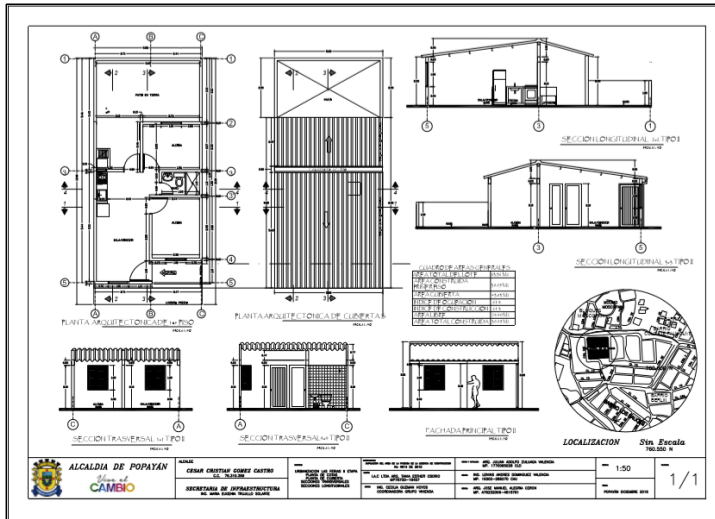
Plano arquitectónico vivienda unifamiliar.
